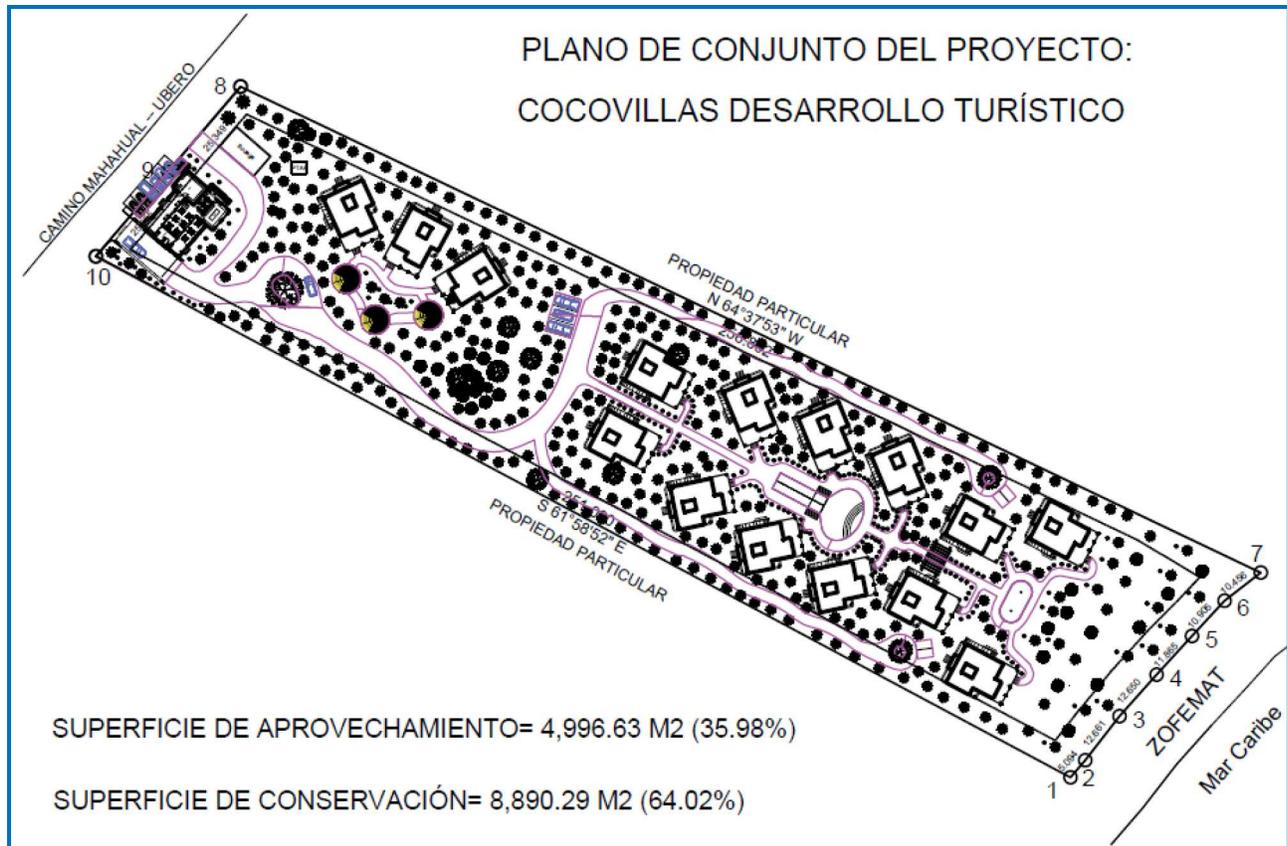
Planta de conjunto del proyecto donde se observa la distribución de las obras que lo integran.
